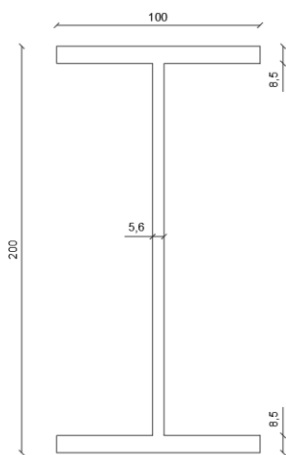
Sezione trasversale dell'asta - Profilo IPE200
